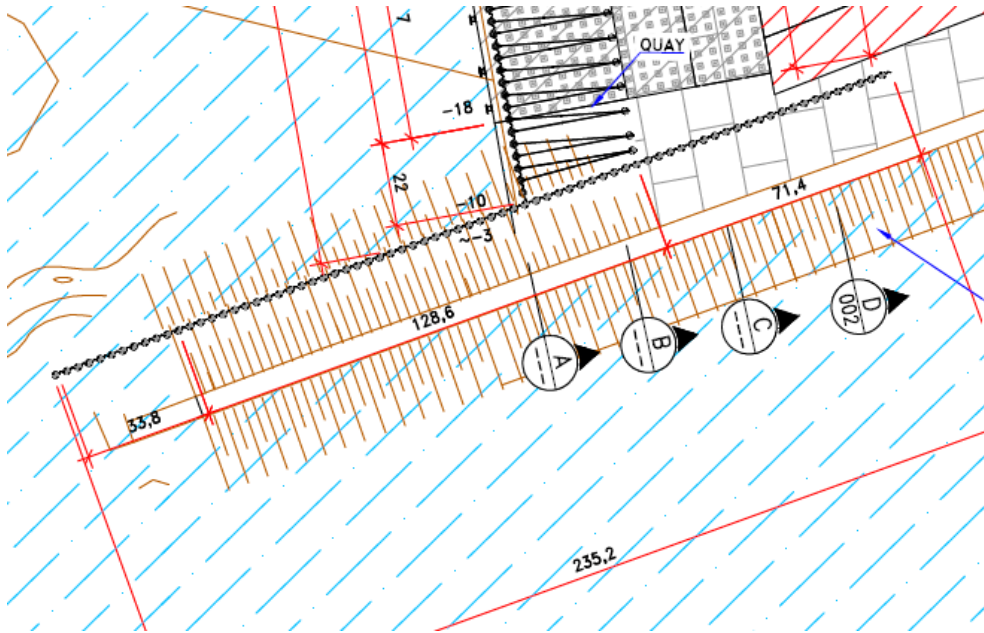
Protección de la escollera Sarandí, muro combi-wall de 235 m de longitud.
